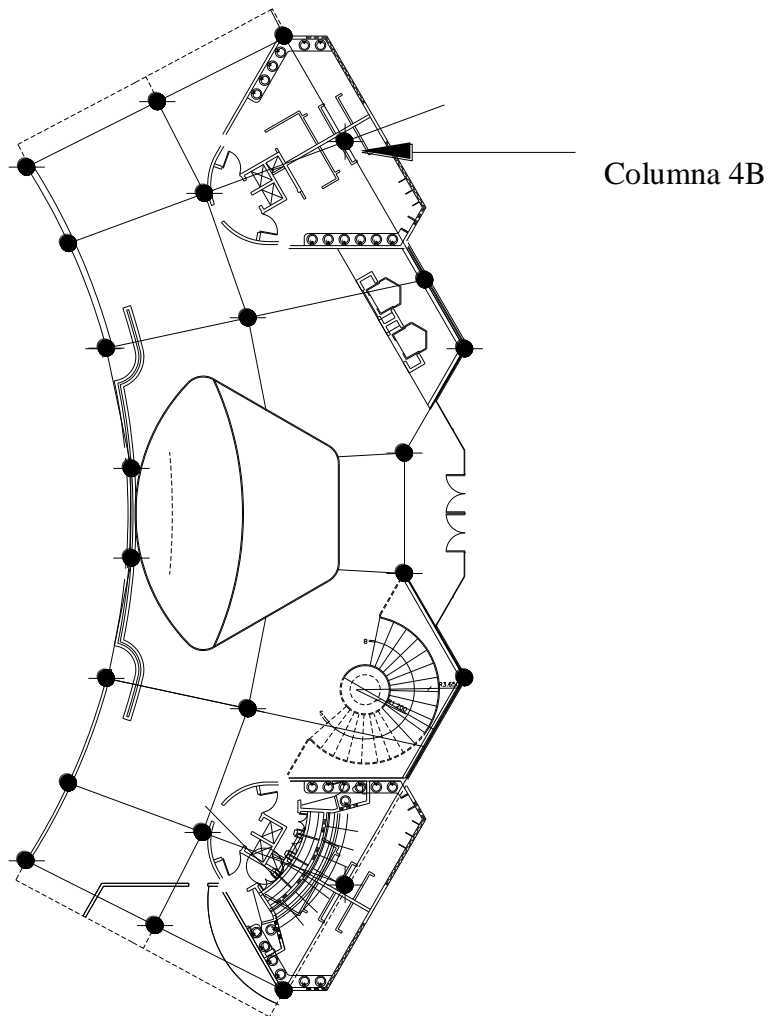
Vista en planta de la ubicación de la columna 4B.
